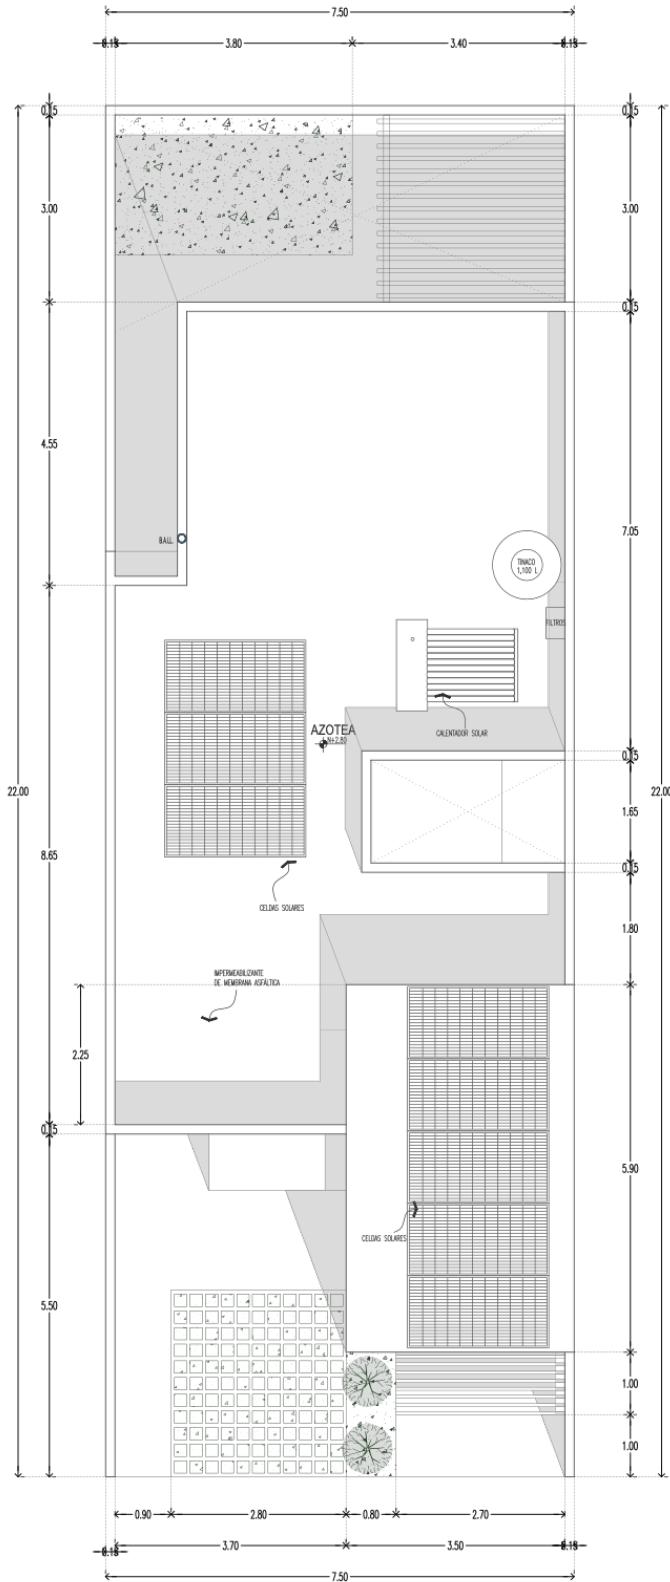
Planta de azotea de la vivienda, etapa 2 y 3a.
